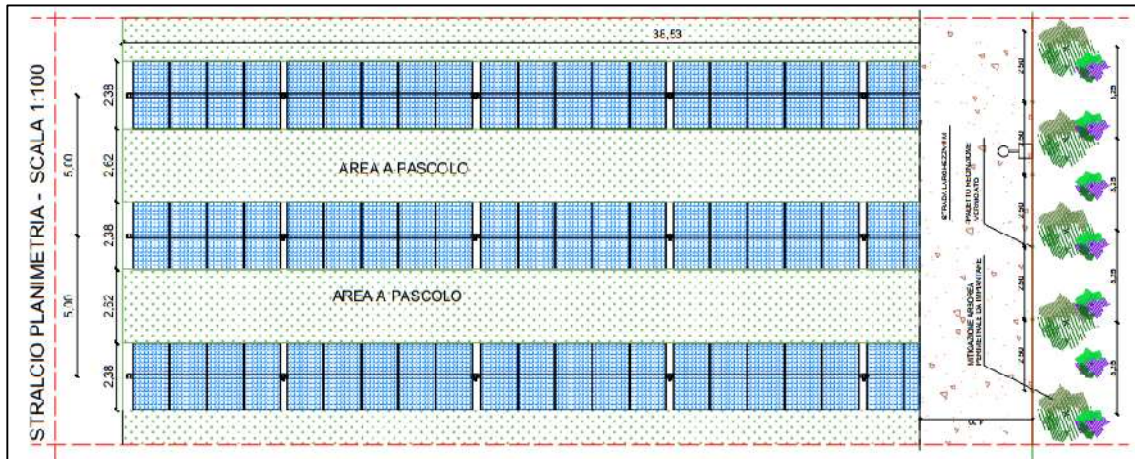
Stralcio planimetrico dell'impianto agrivoltaico.
